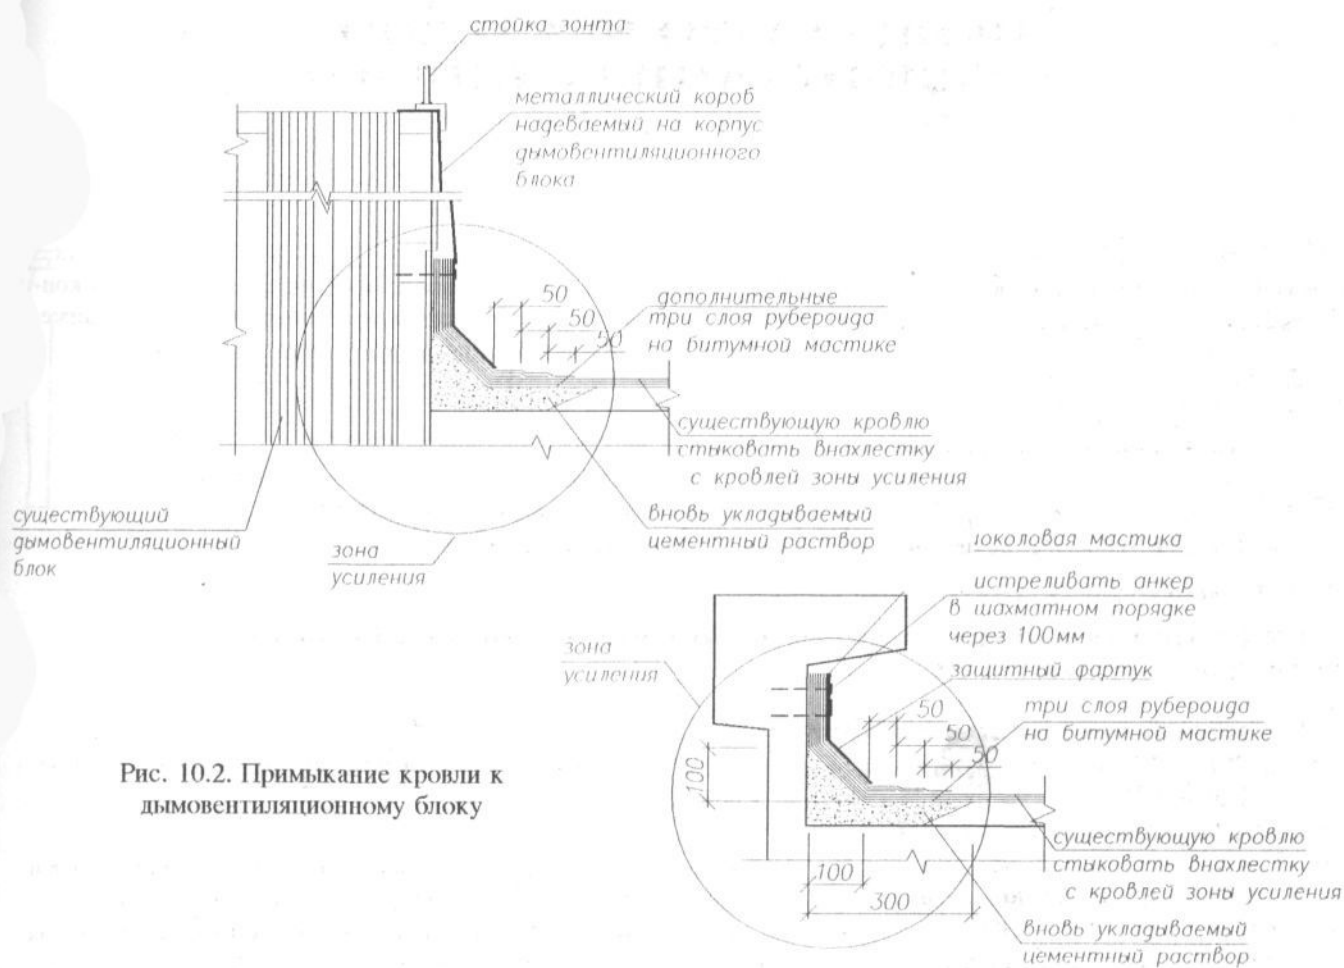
Примыкание кровли к дымовентиляционному блоку
